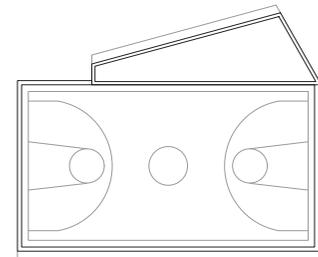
Vertical Gym, Grundrisse M 1:700 [PS, 2020]
